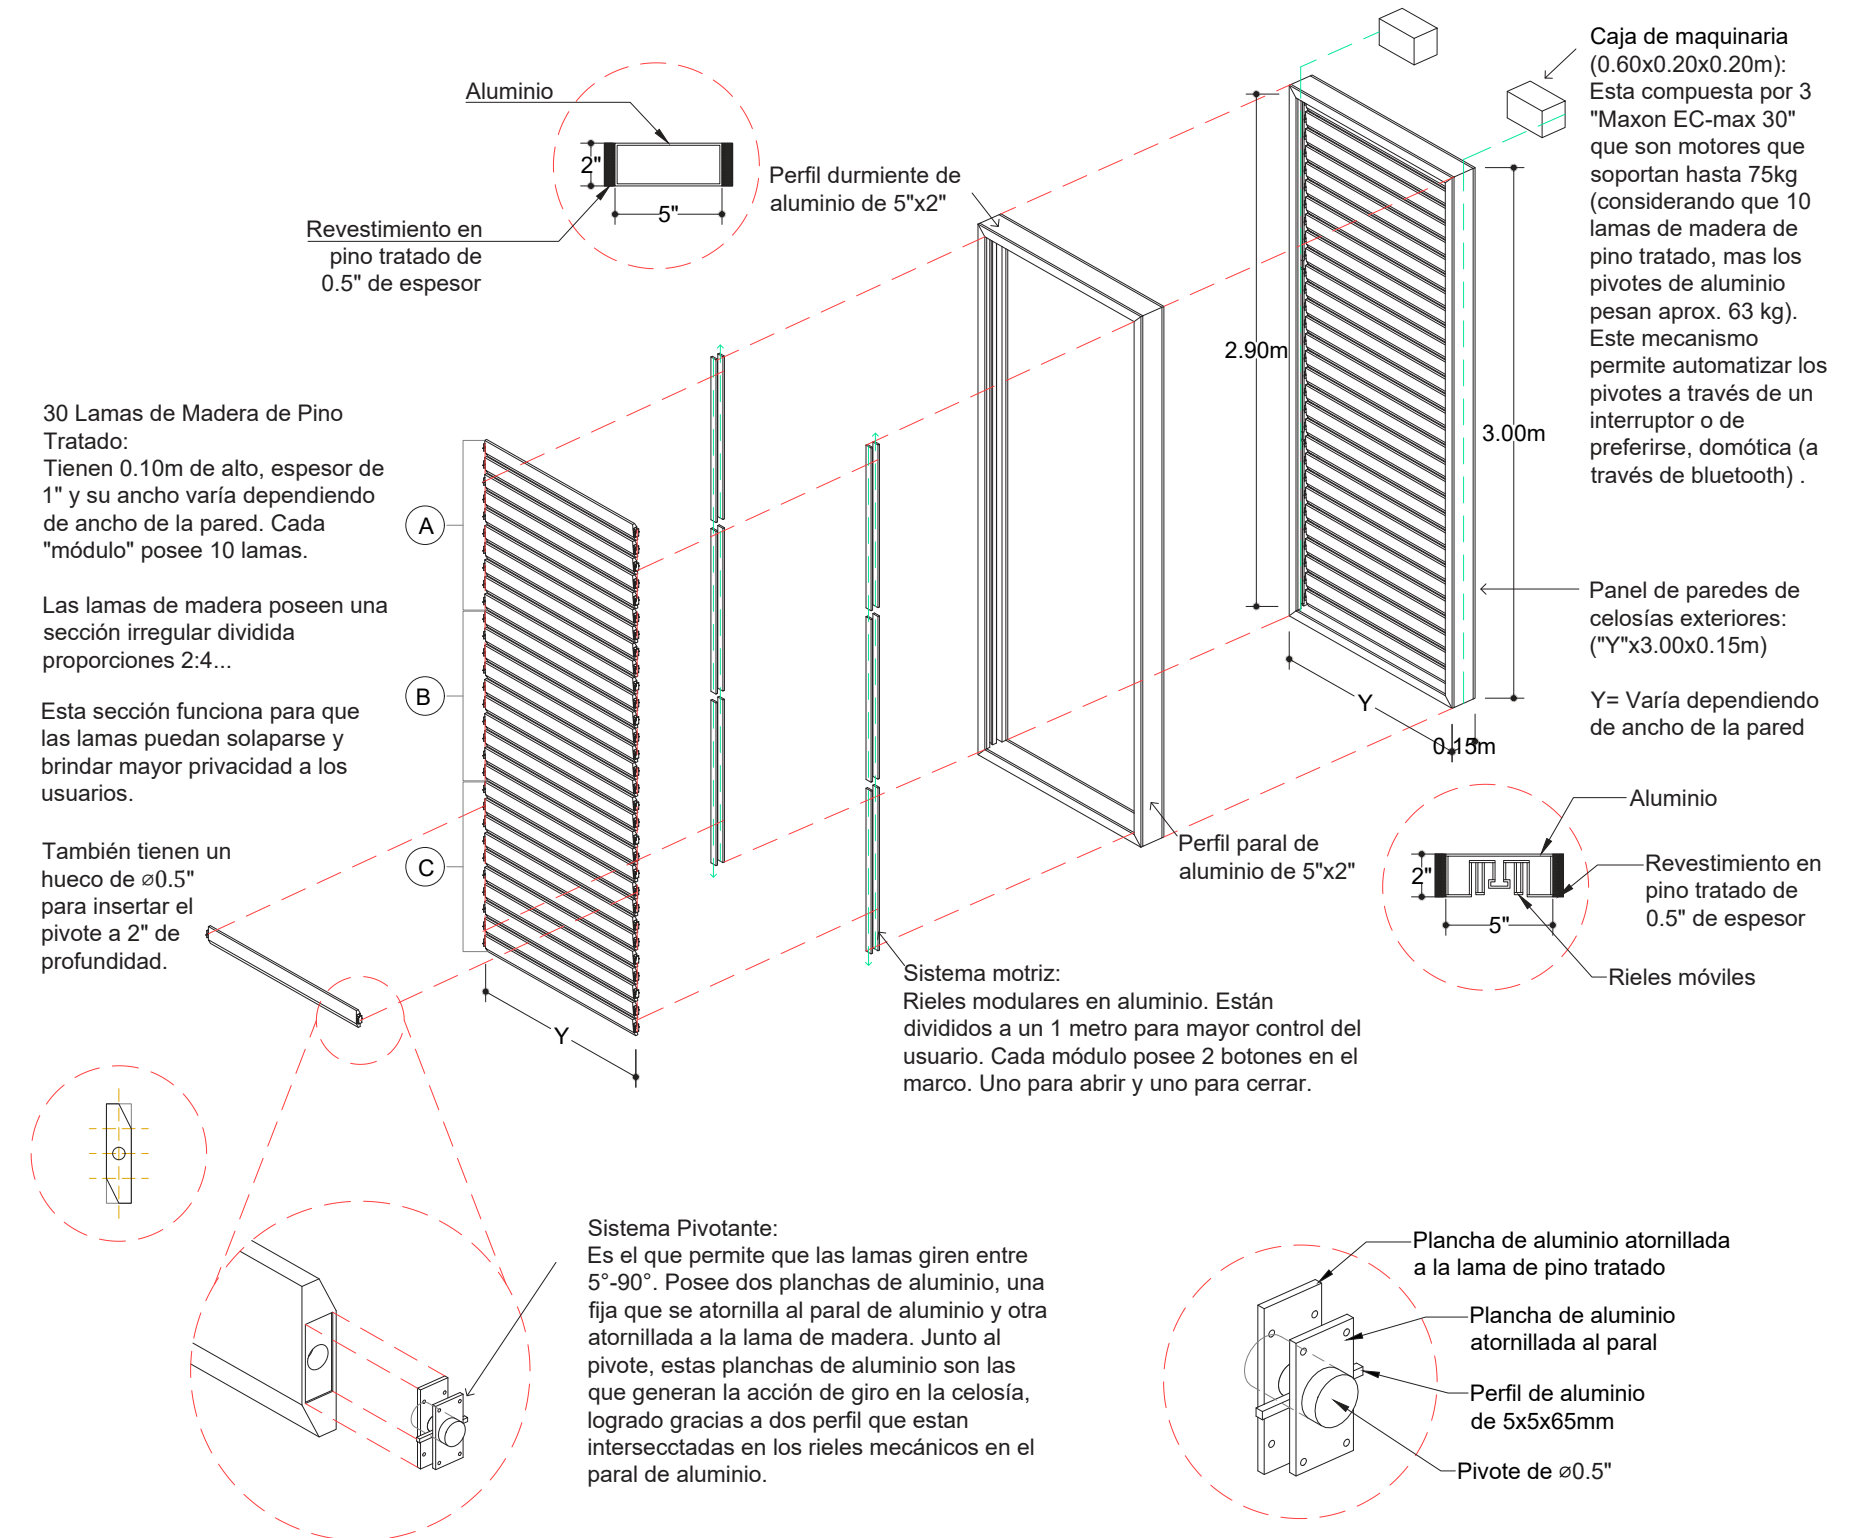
Detalle: "Despiece de paredes de celosías exteriores". Elaboración propia.
